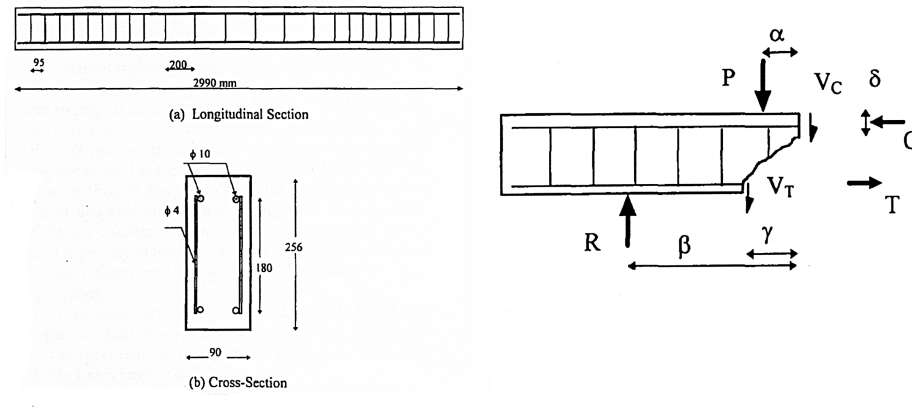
Gleichgewicht am Schrägriss nach Boutros/Saverimutto [22]
